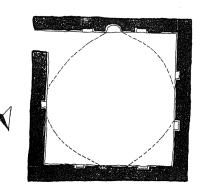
ضريح بالجانب الجنوبي الشرقي من الجانة الشرقية مسقط أفقي
